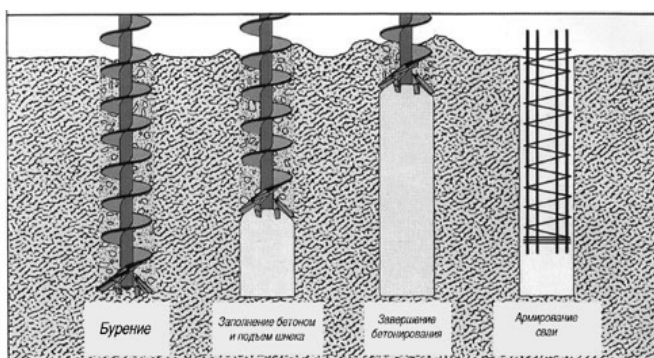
Формування бурового фундаменту з залізобетонних паль
